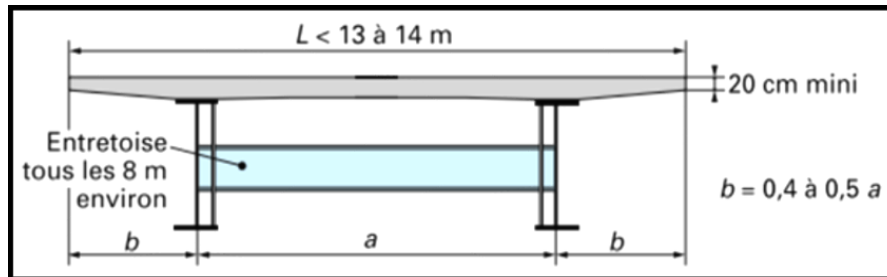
Coupe transversale d'un tablier bipoutre.
